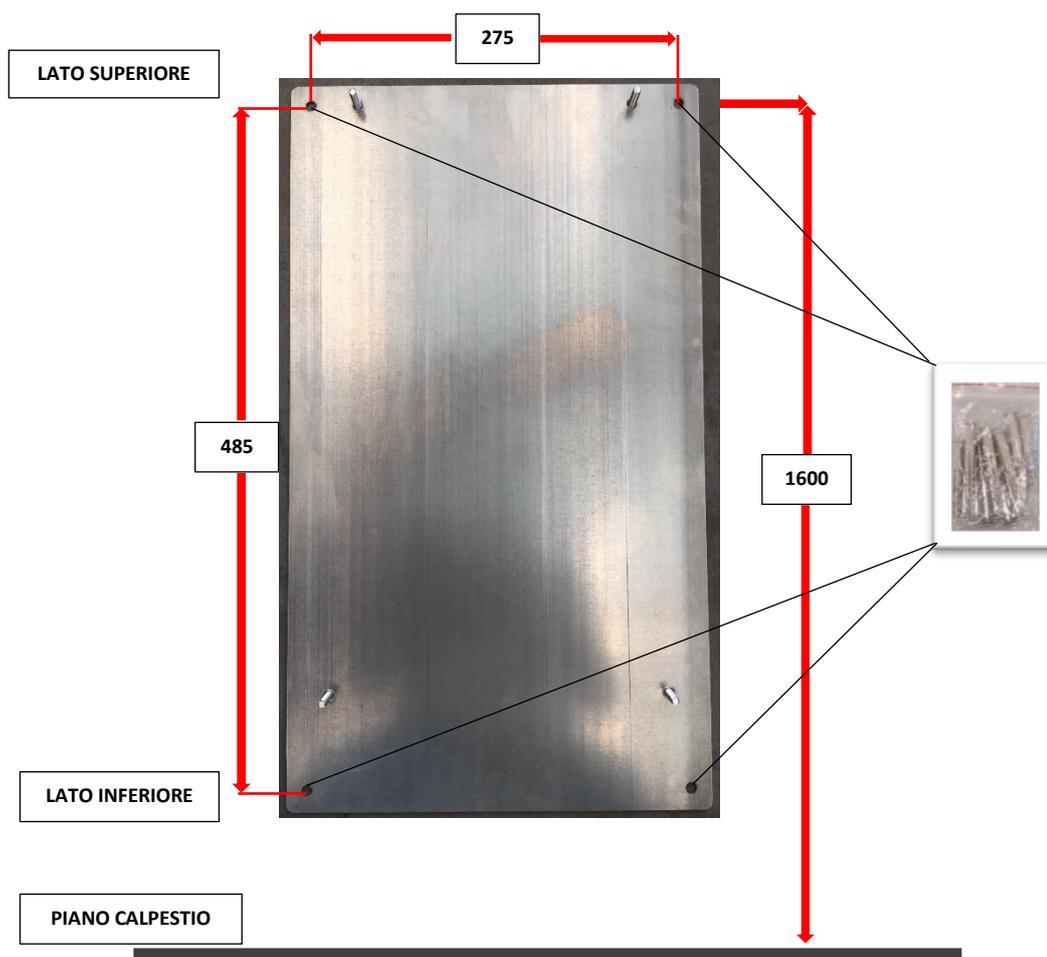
Altezza minima di installazione della piastra di supporto (mm)
